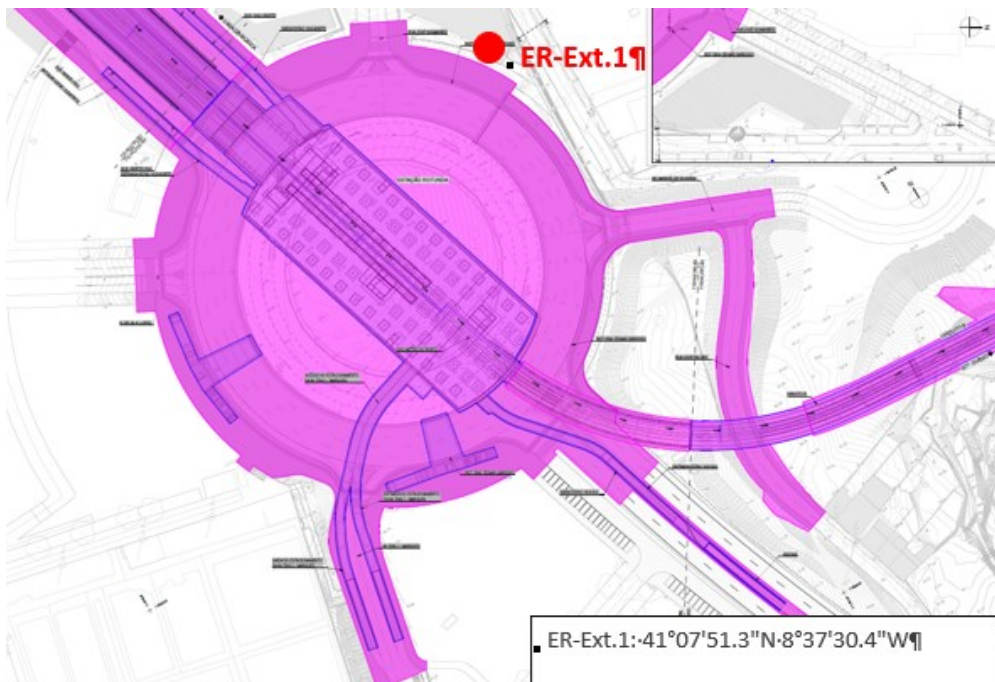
Pontos de monitorização junto Estação Rotunda (vibrações – construção)
